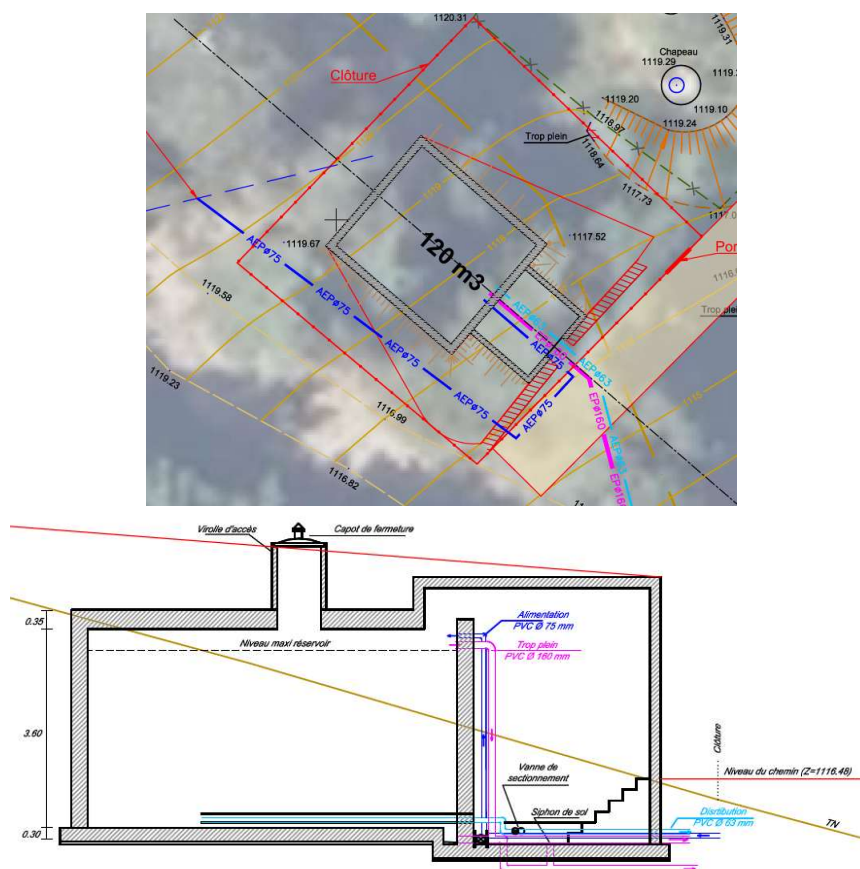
Extrait du plan de masse et de la coupe du projet phase AVP (28/01/2026)
